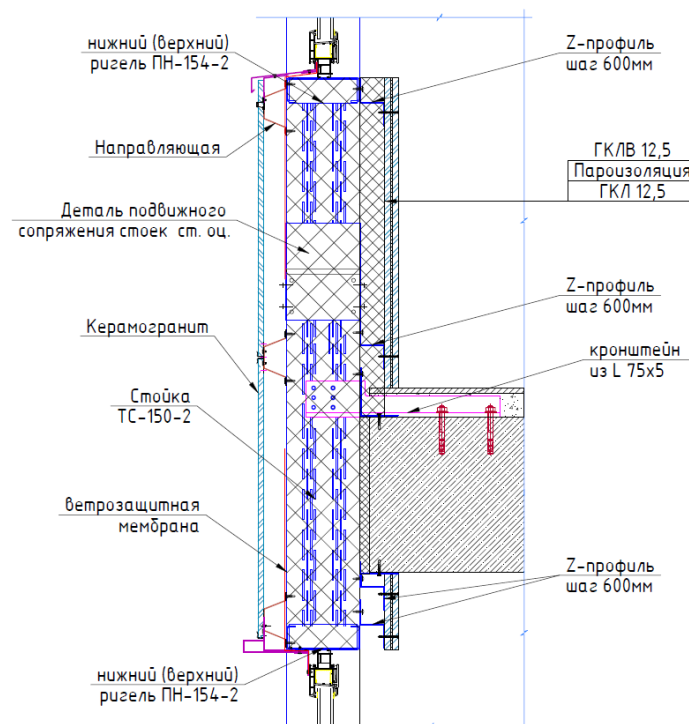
Узел крепления термокаркаса к несущим конструкциям (плита перекрытия).
